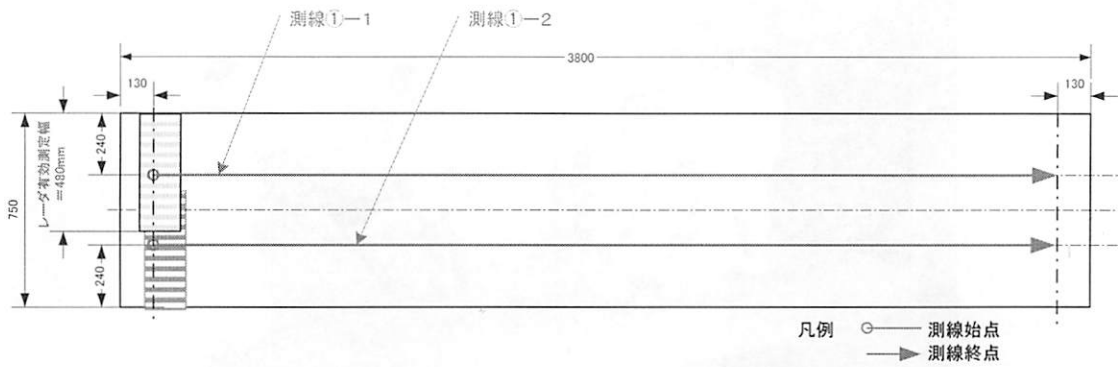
供試体①の平面図とMPLAレーダアンテナ走査位置
